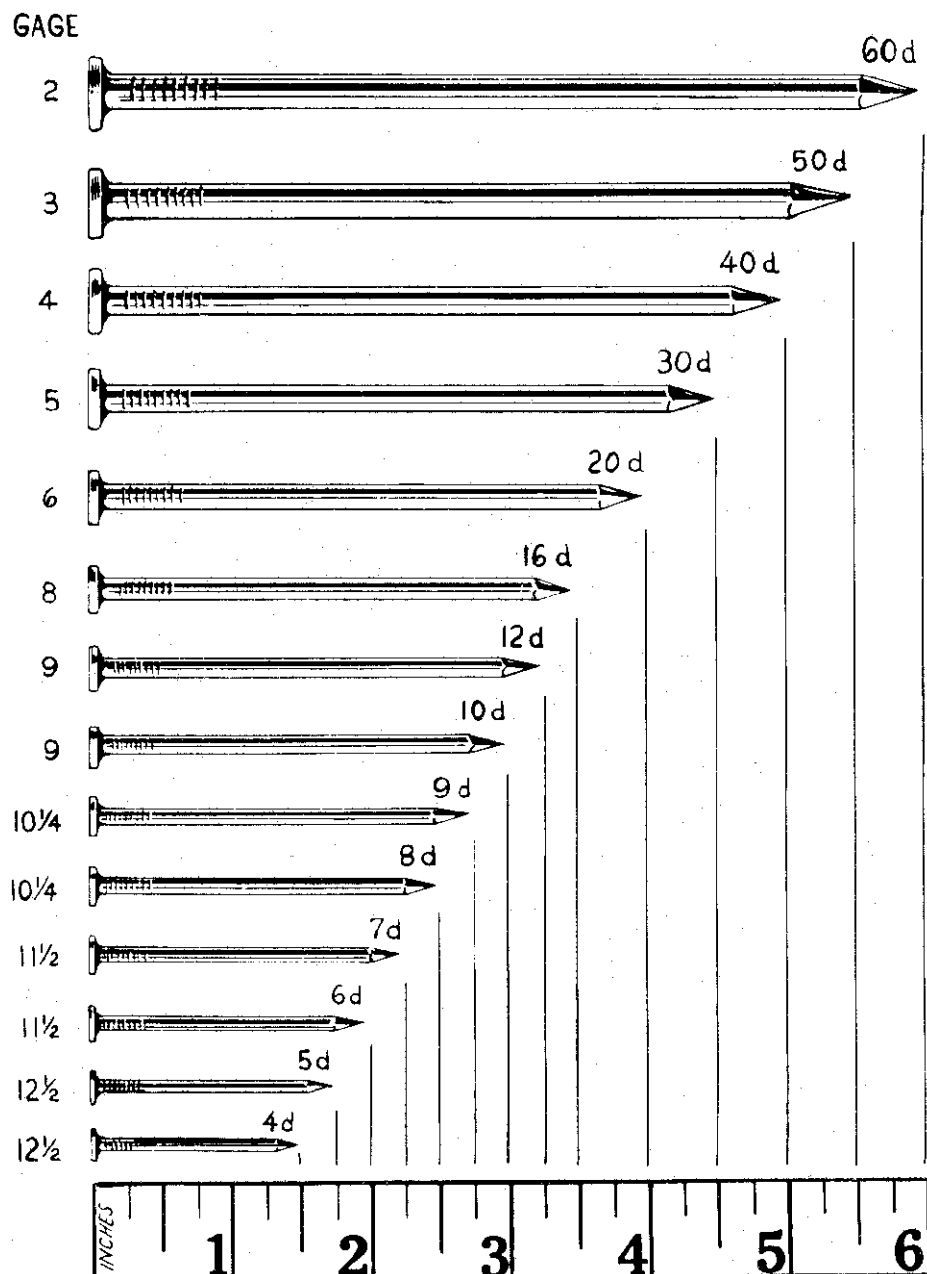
Exemplo dos tamanhos de prego mais utilizados nos EUA para a construção de edificação no sistema plataforma
